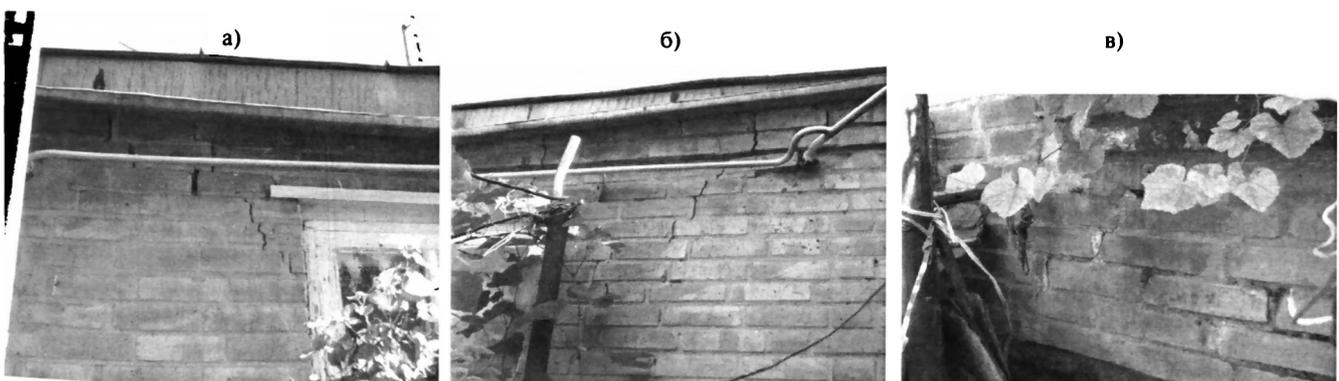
Трещины в верхней зоне кирпичной облицовки наружной стены дома по пер. Аджамский, 27: а, б, в - ширина раскрытия трещин до 4, 8 и 12 мм, соответственно.
